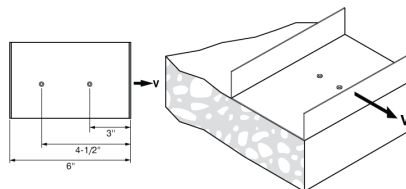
Une fixation de rail de 3-5/8 po (92,1 mm) ou 6 po (152,4 mm)
